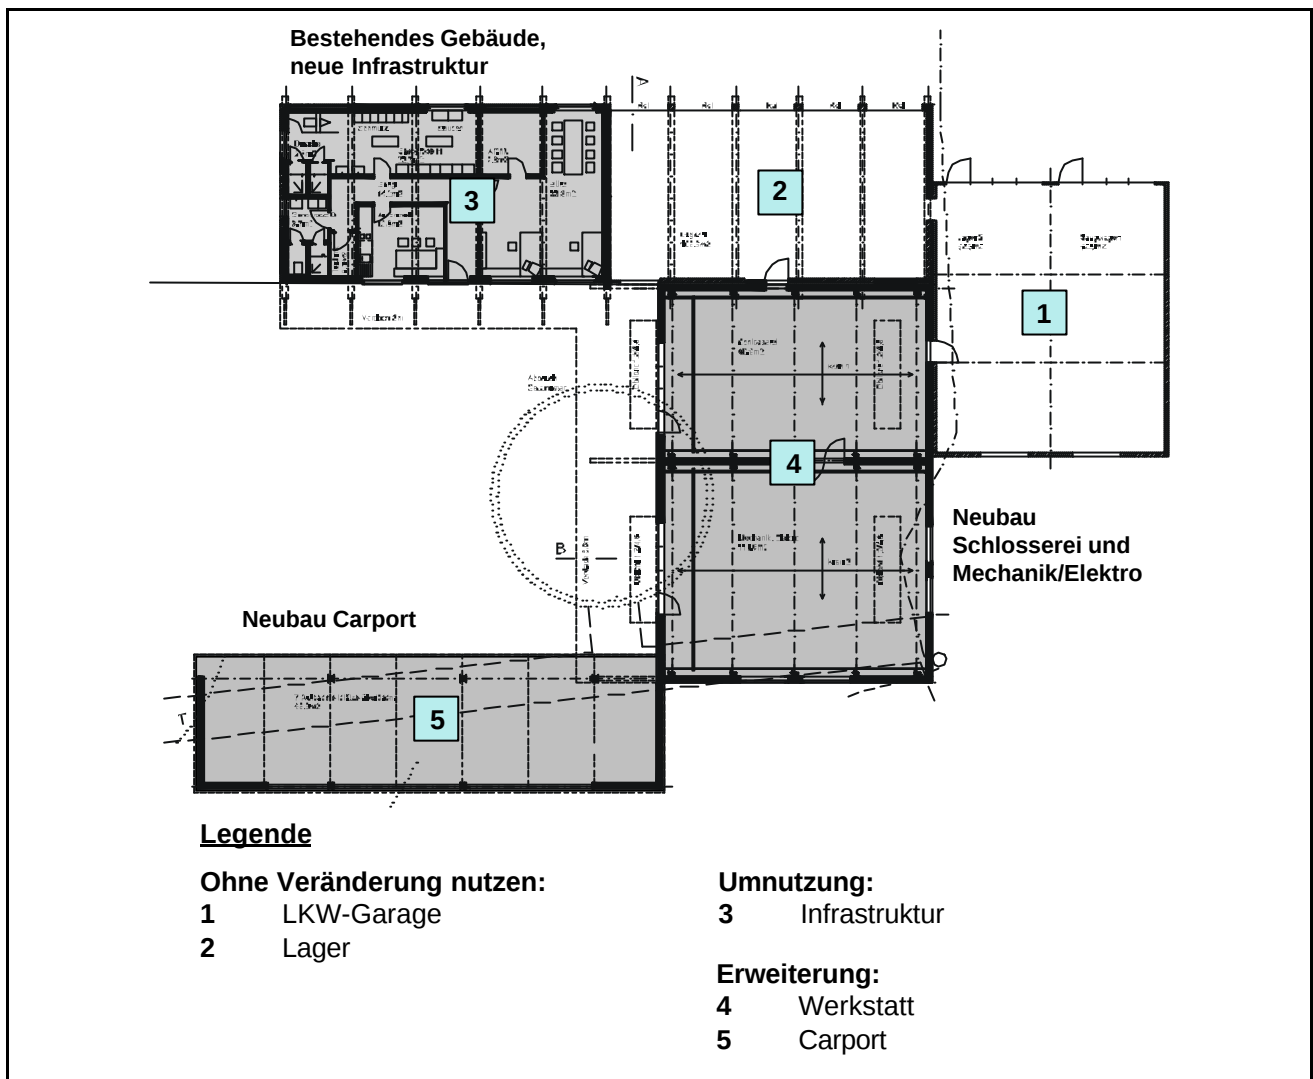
Übersichtsplan mit geplanten Gebäuden "Anlagen im Netz"
